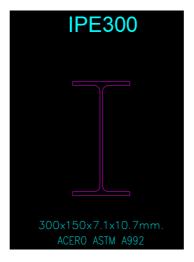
Dibujo del perfil IPE300 en AutoCAD.
